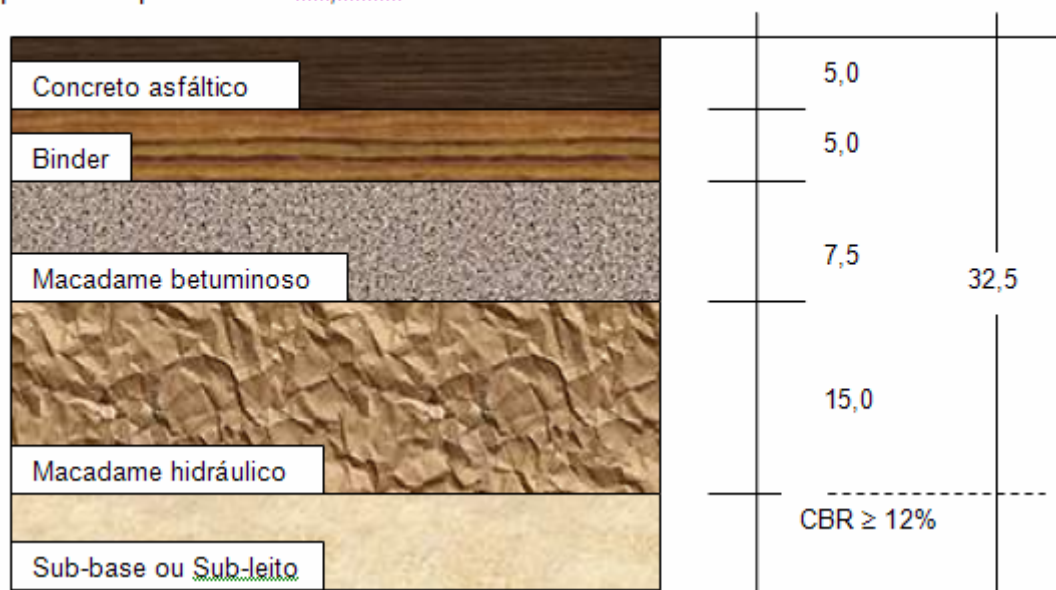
Seção tipo do pavimento da Avenida dos Bandeirantes, para Tipo C-2 (PMSP, 1967).
